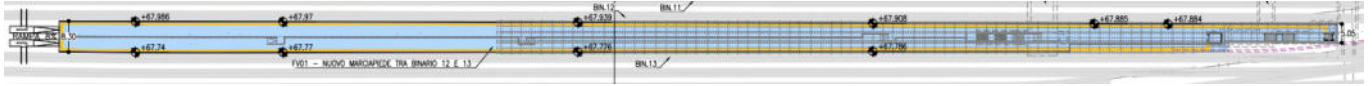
Nuovo marciapiede binario 12 e 13 – Stralcio planimetrico
